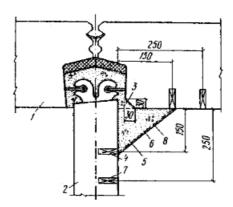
Утепление вертикального рядового стыка в месте примыкания перегородки к наружным стеновым панелям
